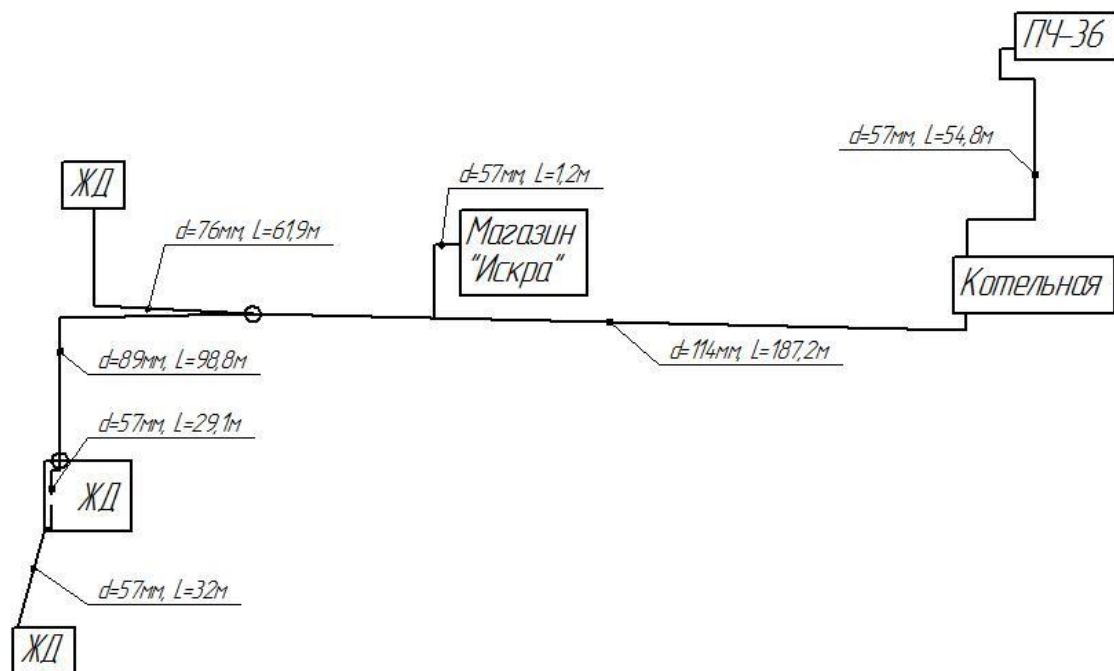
Схема тепловых сетей котельной №2
